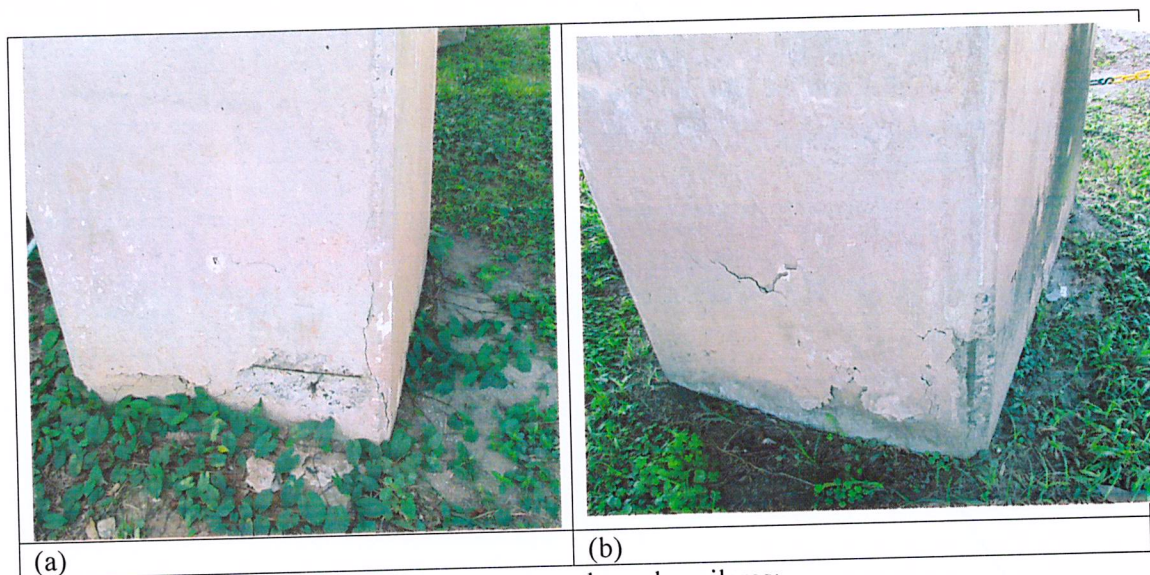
(a) e (b) trincas e armaduras exposta na base dos pilares;
